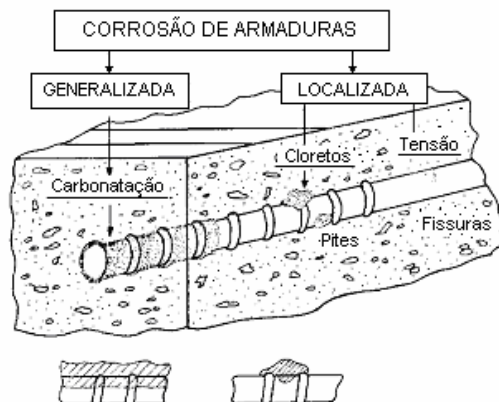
Corrosão das armaduras – tipos e fatores (ANDRADE, 1992)
